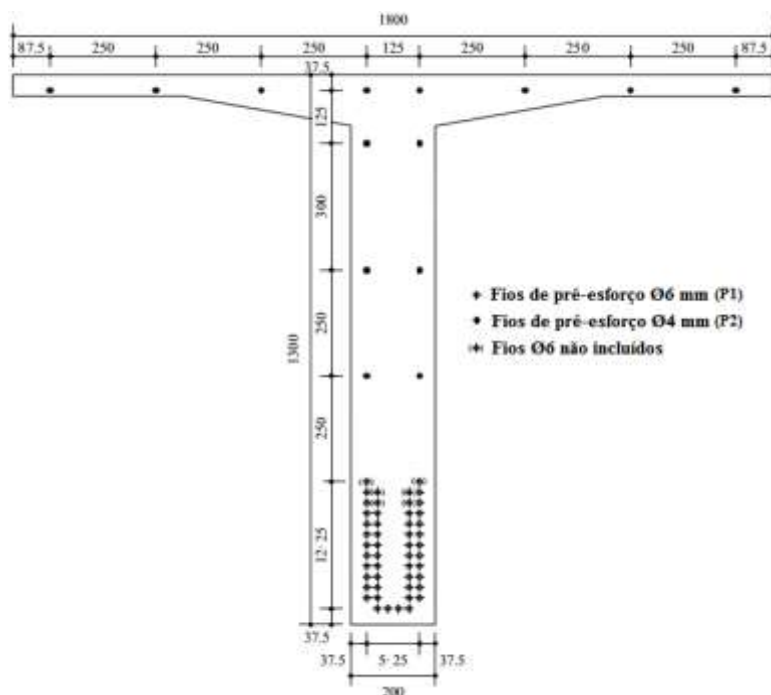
Armadura de pré-esforço prevista e efectivamente colocada na secção transversal das vigas [38].
